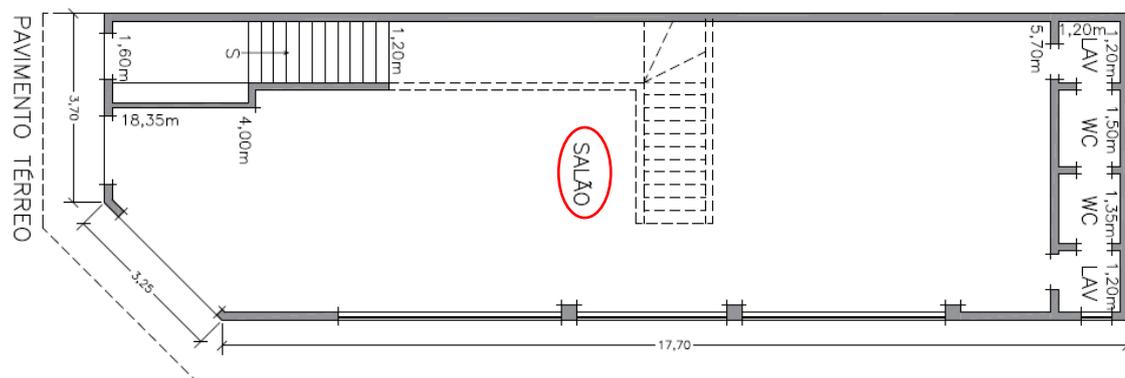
Planta baixa do pavimento térreo da edificação avaliada. Destaque para a loja e para a escada que dá acesso aos apartamentos dos pavimentos superiores.
